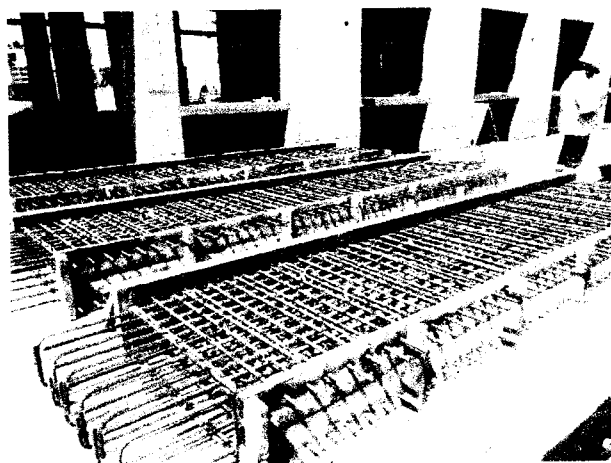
Encofrados de losas y armaduras de acero  $f'y=4200 \text{ kg/cm}^2$
